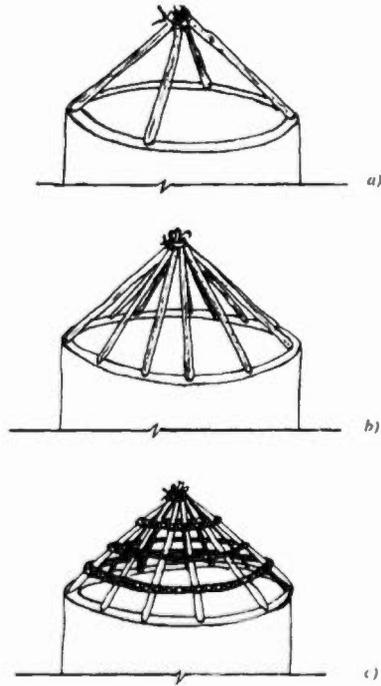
Schéma du montage d'une toiture en 3 étapes (Kéré, 1995, p.25)
